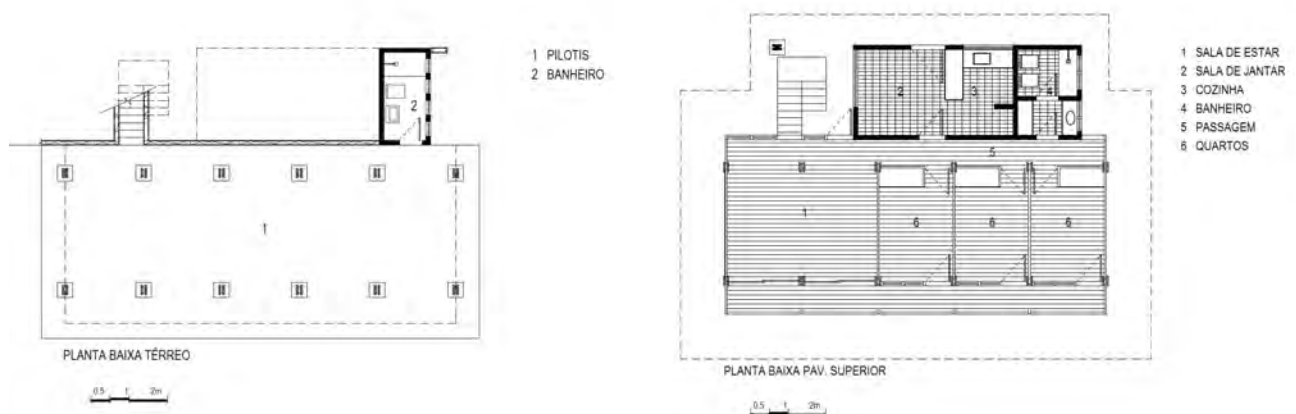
e 14 - Recife, 1762. Planta térreo | Planta segundo pavimento.
